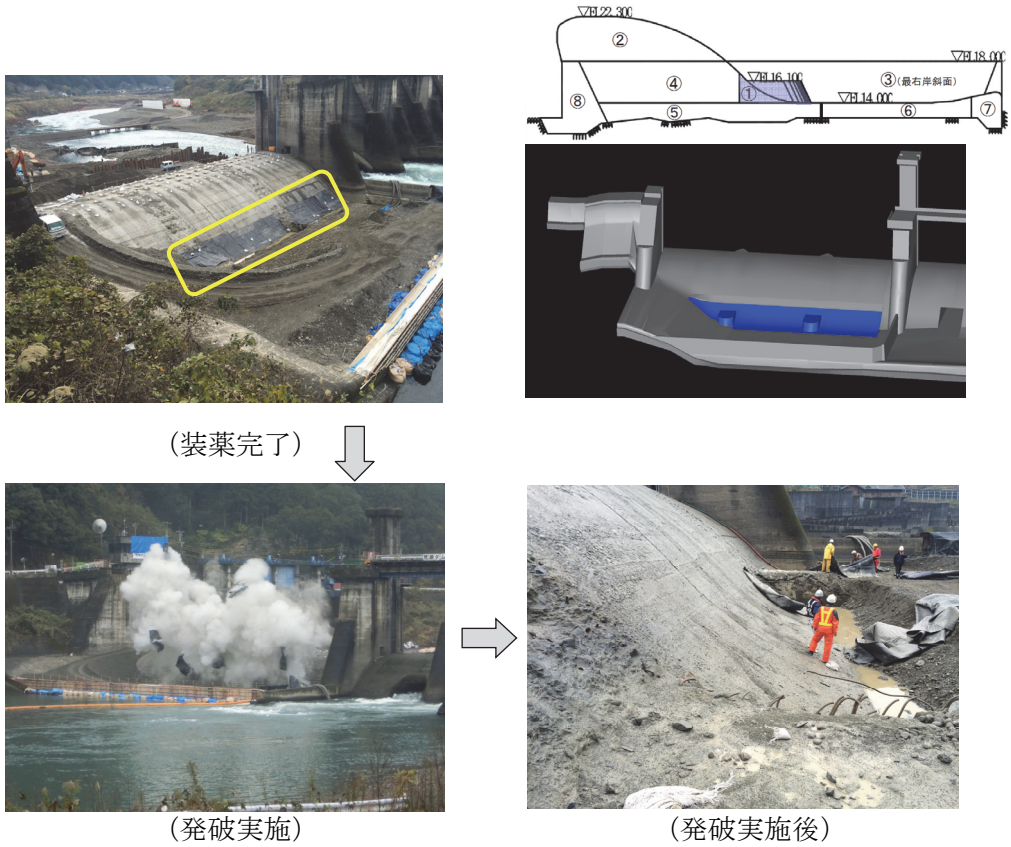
右岸みお筋部の撤去状況 (①門柱下部)
